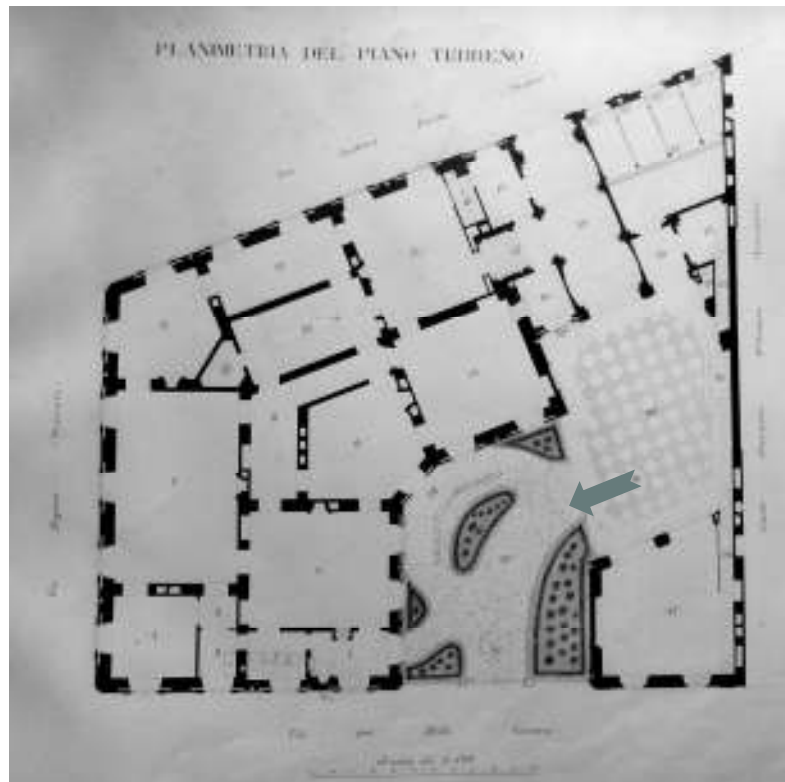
Planimetria del piano terreno (Angelo Marchelli, 1886): punteggiata l'area ora occupata dall'Accademia di Agricoltura di Torino.
